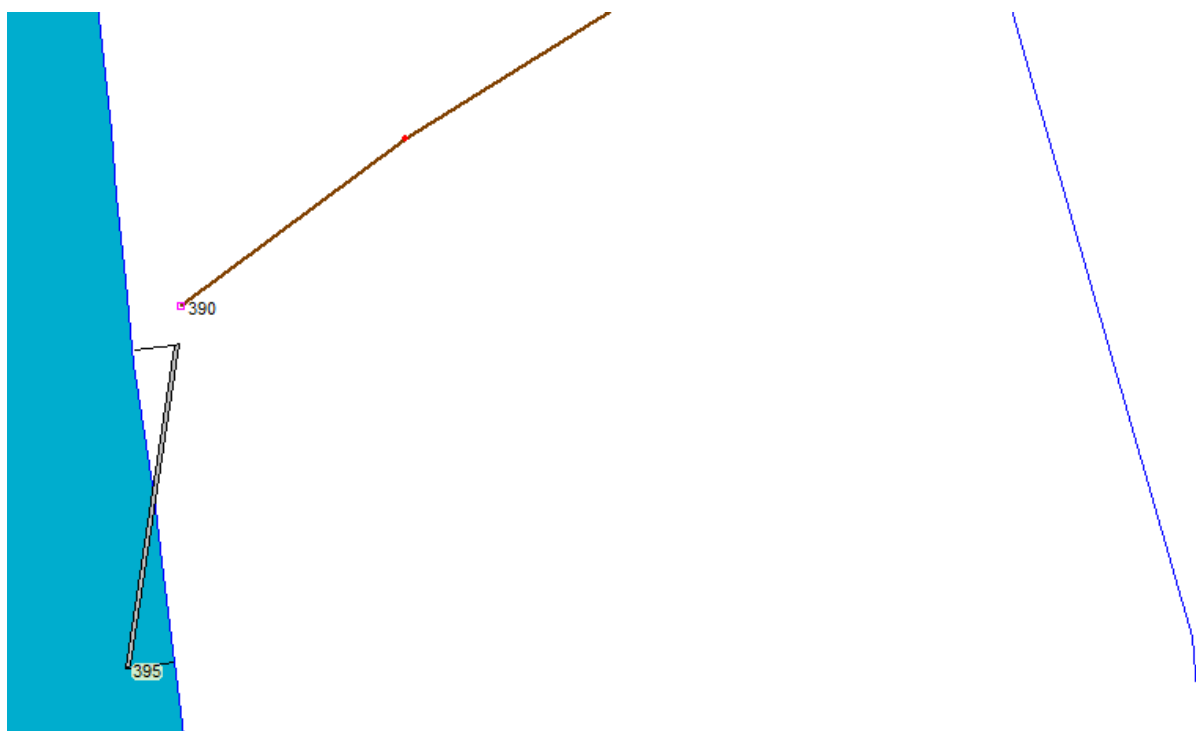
Raffigurazione scarico cassa monte: lateral structure.
